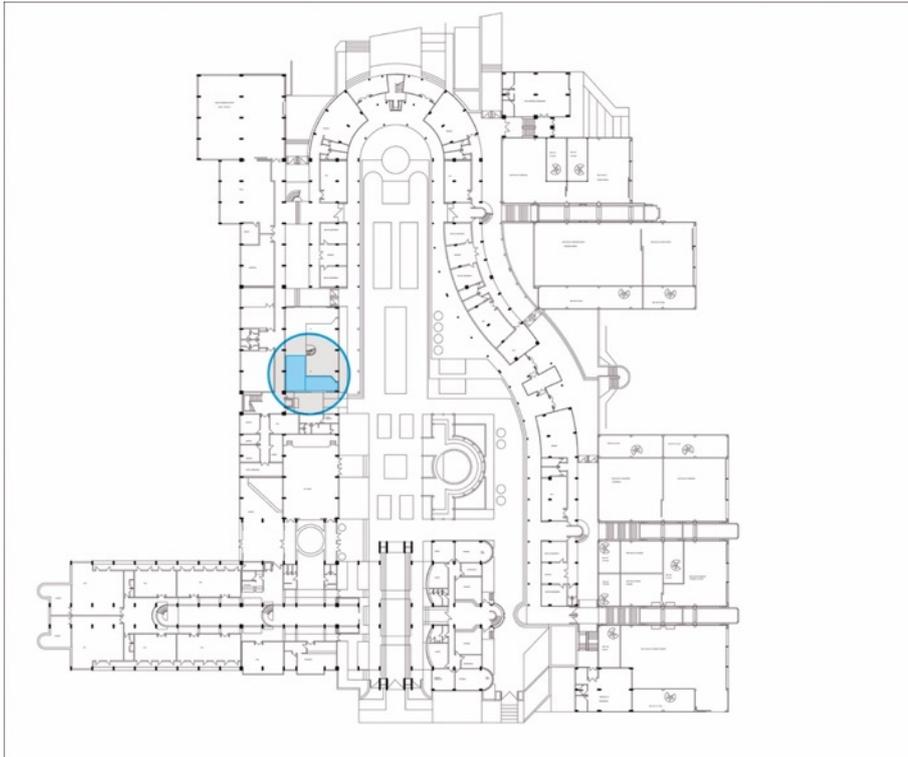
Plano general planta alta Edificios de Ingenierías de la ULPGC.
